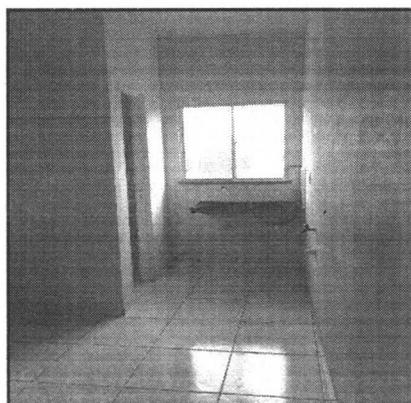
Vista da área de serviço, com piso em cerâmica e esquadria de alumínio e vidro
